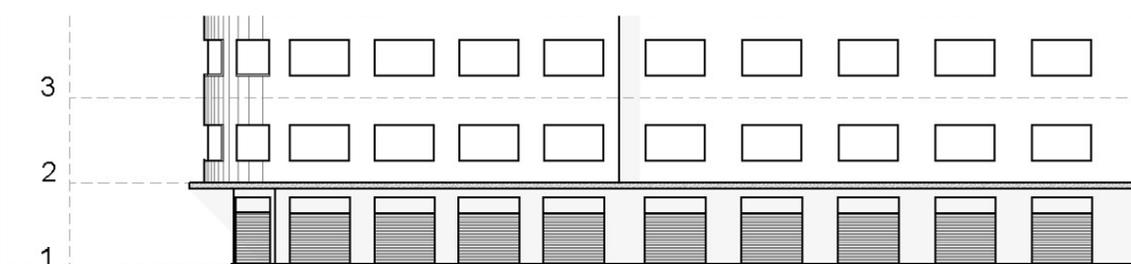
Sección Común del Plano de Detalle sectores Entorno Mercado y Ejes Rengo – Caupolicán. Fuente: PLAN SECCIONAL DE REMODELACIÓN Y PLANO SECCIONAL, CONCEPCIÓN CENTRO Plano de Detalle.)
